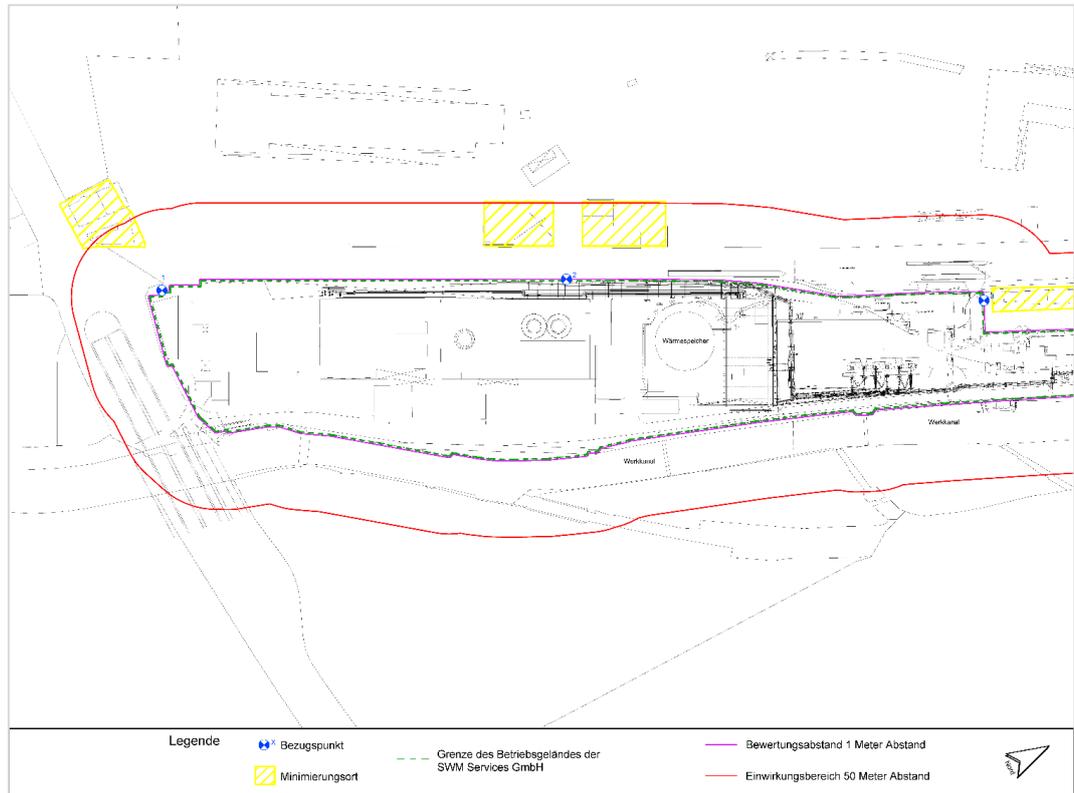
Lageplan des Heizkraftwerks mit eingezeichneten Bezugspunkten sowie Einwirkungsbereich und Bewertungsabstand.
